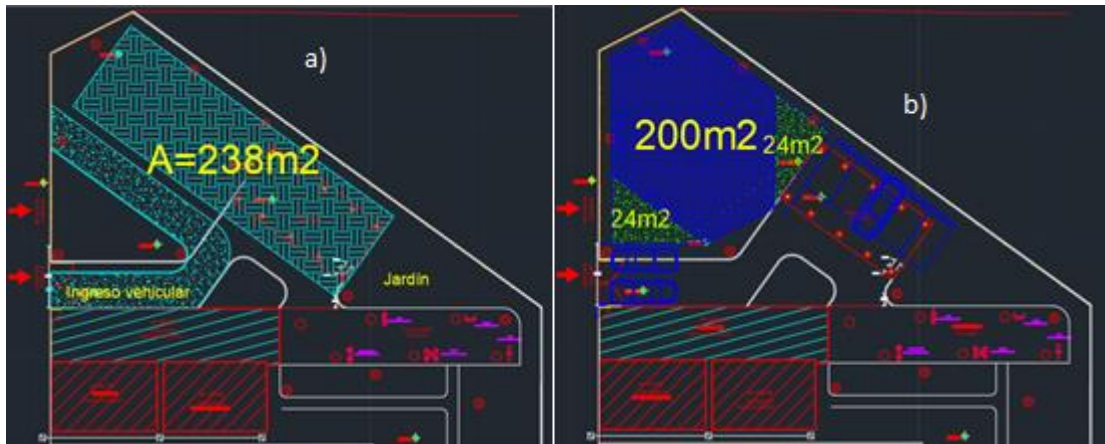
Alternativas arquitectónicas. a) Alternativa 1. b) Alternativa 2
